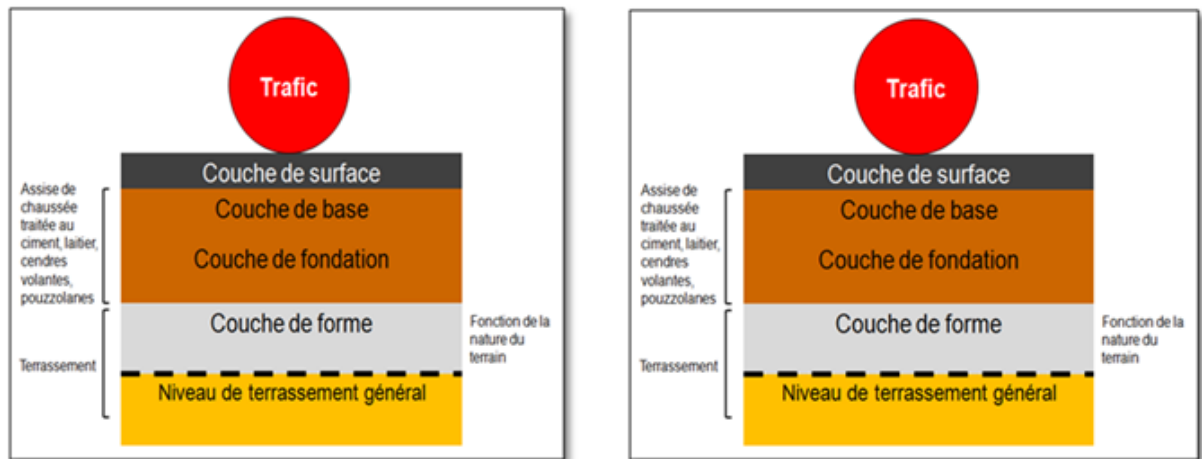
Structure type d'une chaussée semi-rigide.
